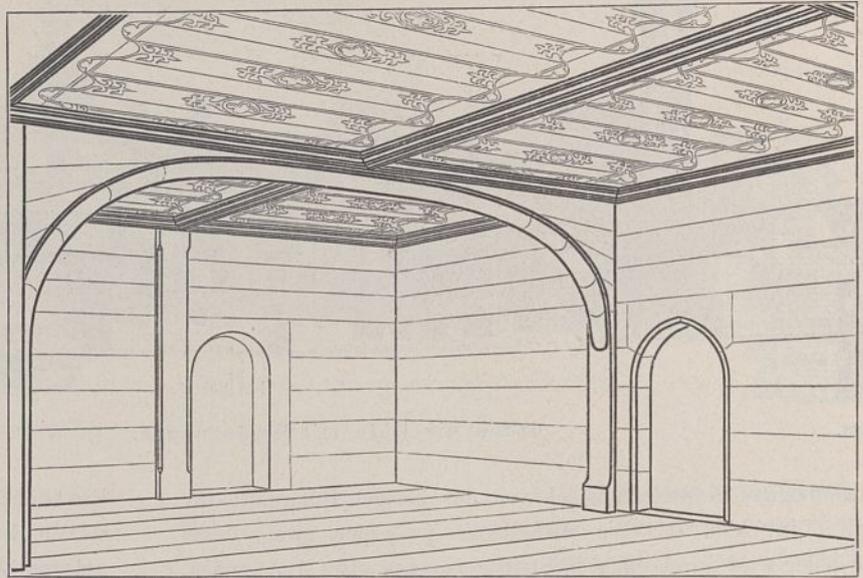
Zimmer mit geschnitzter und bemalter Holzdecke im zweiten Obergeschoß des Alten Schlosses.
